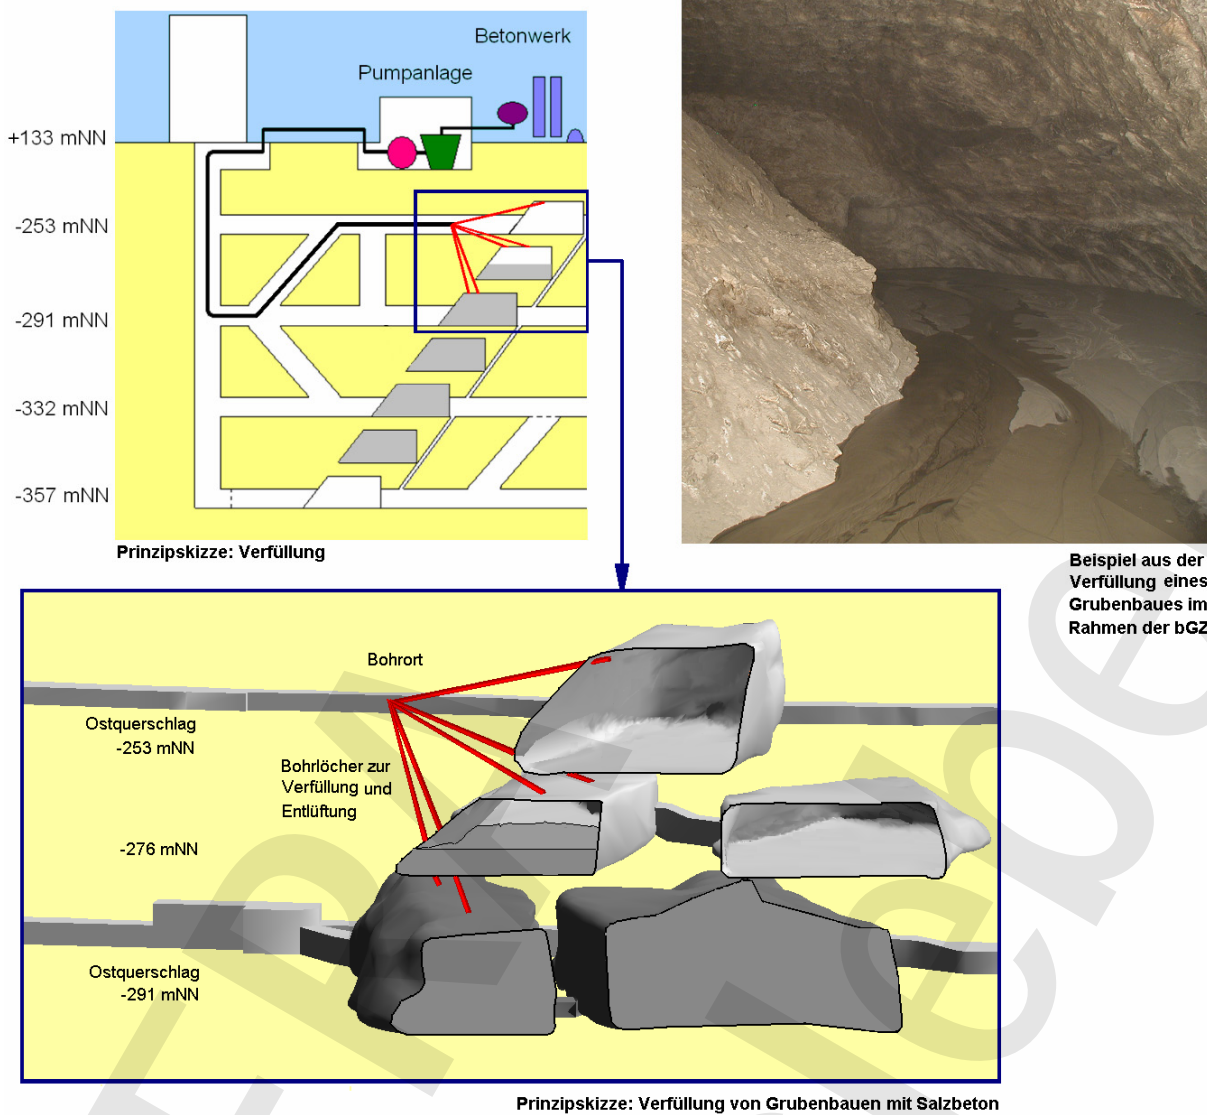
Verfüllen von Grubenbauen mit Salzbeton.
